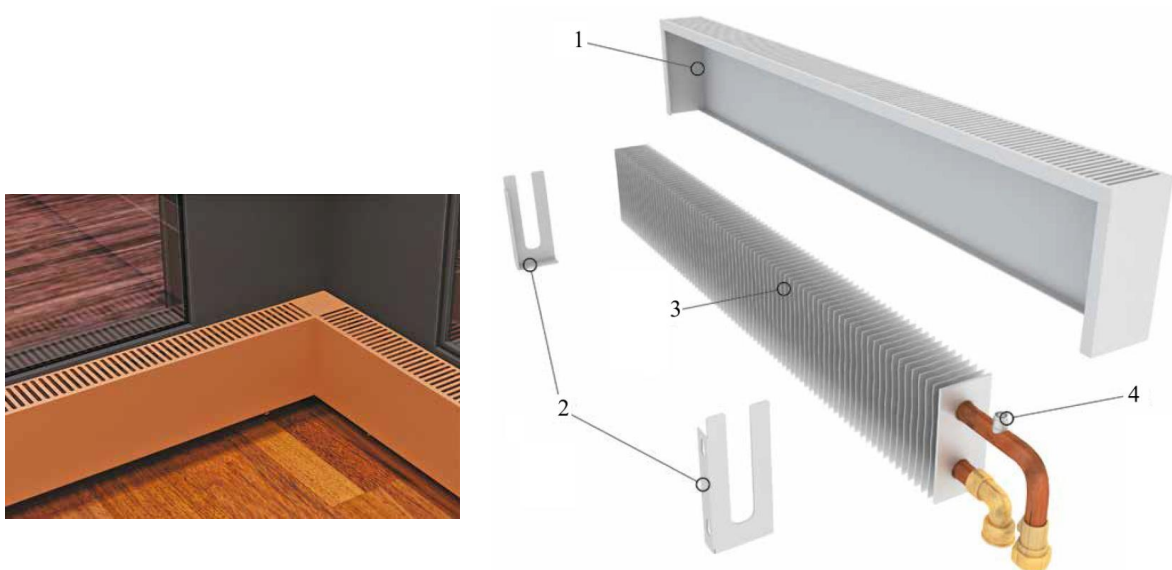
Плинтусный конвектор «Techno Board»
